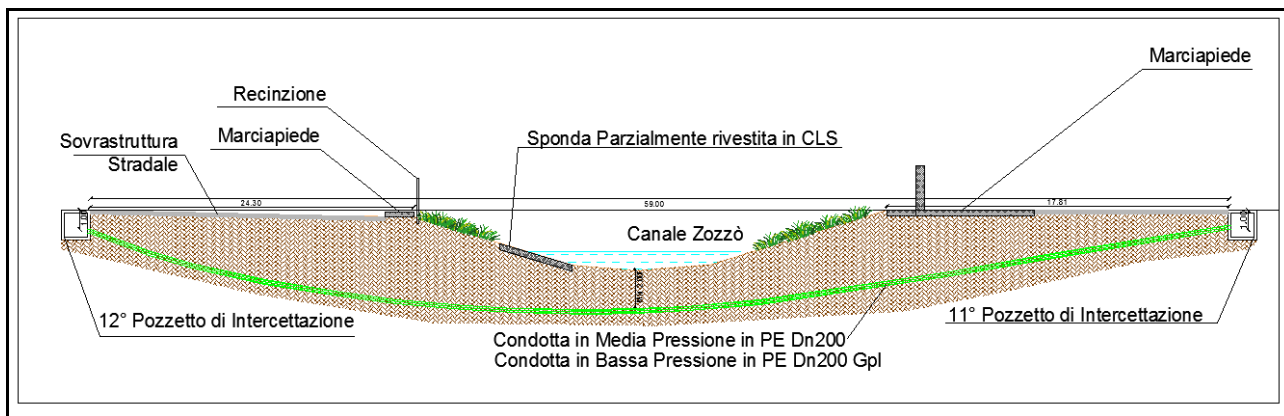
Sezione di progetto. Attraversamento del Canale Zozzò con tecnologia T.O.C..
